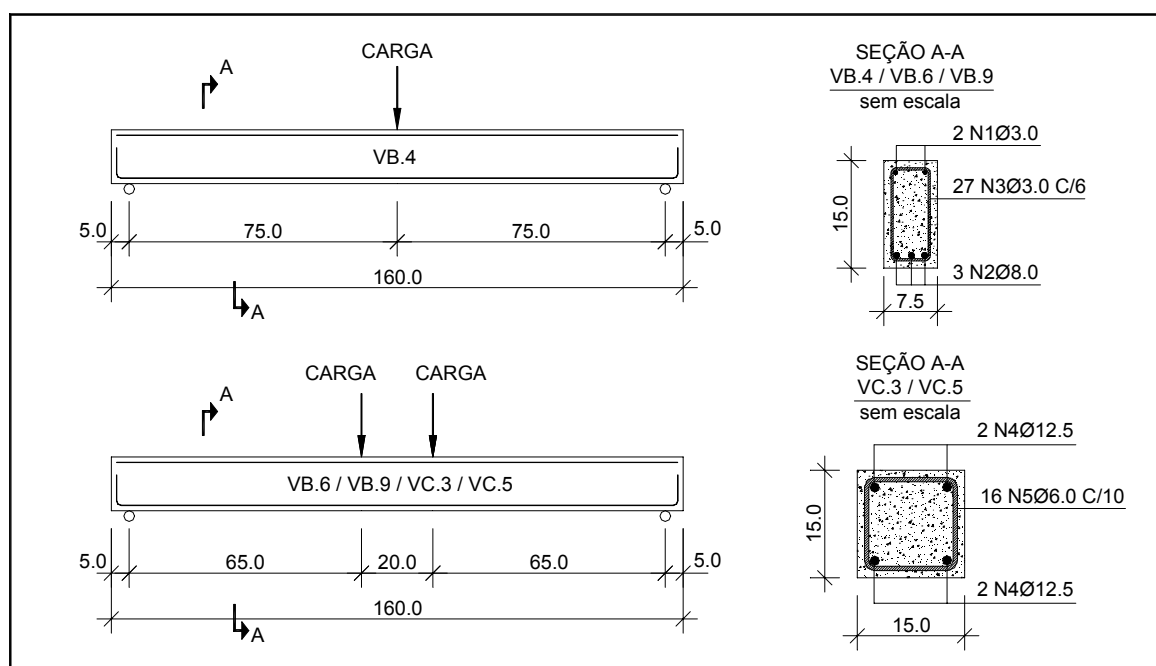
Dimensões e detalhamento das vigas ensaiadas
